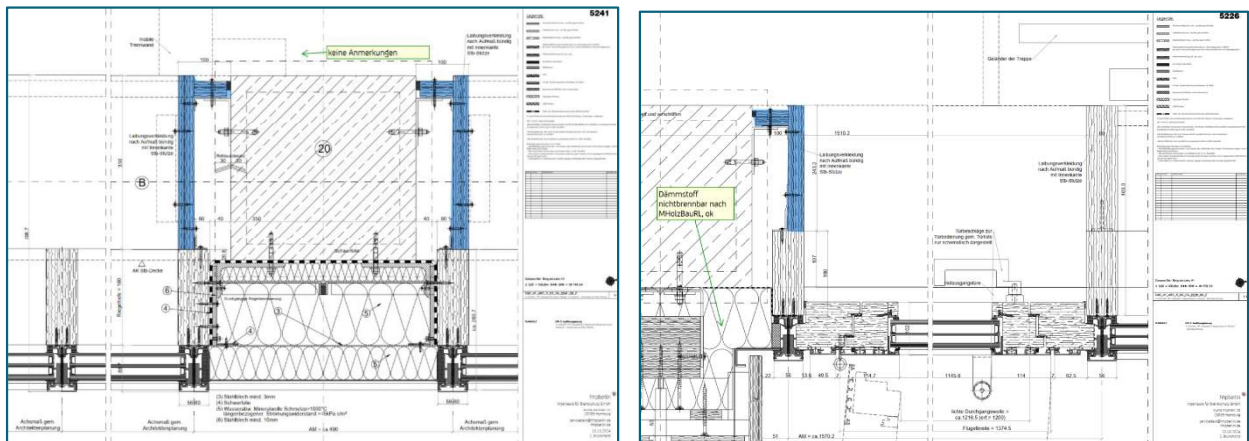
Auszug aus /DP_Leibungen_TRH 2/, Grundrisse mit Darstellung von Pfosten-Riegel-Fassade (Holz-Aluminium-Konstruktion) und Leibungsbekleidung aus Holz (blau markiert)
